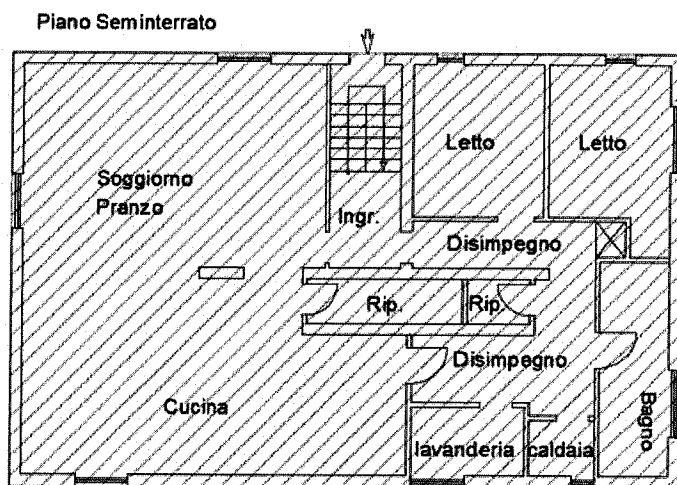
Planimetria Piano Seminterrato – calcolo Superfici commerciale
